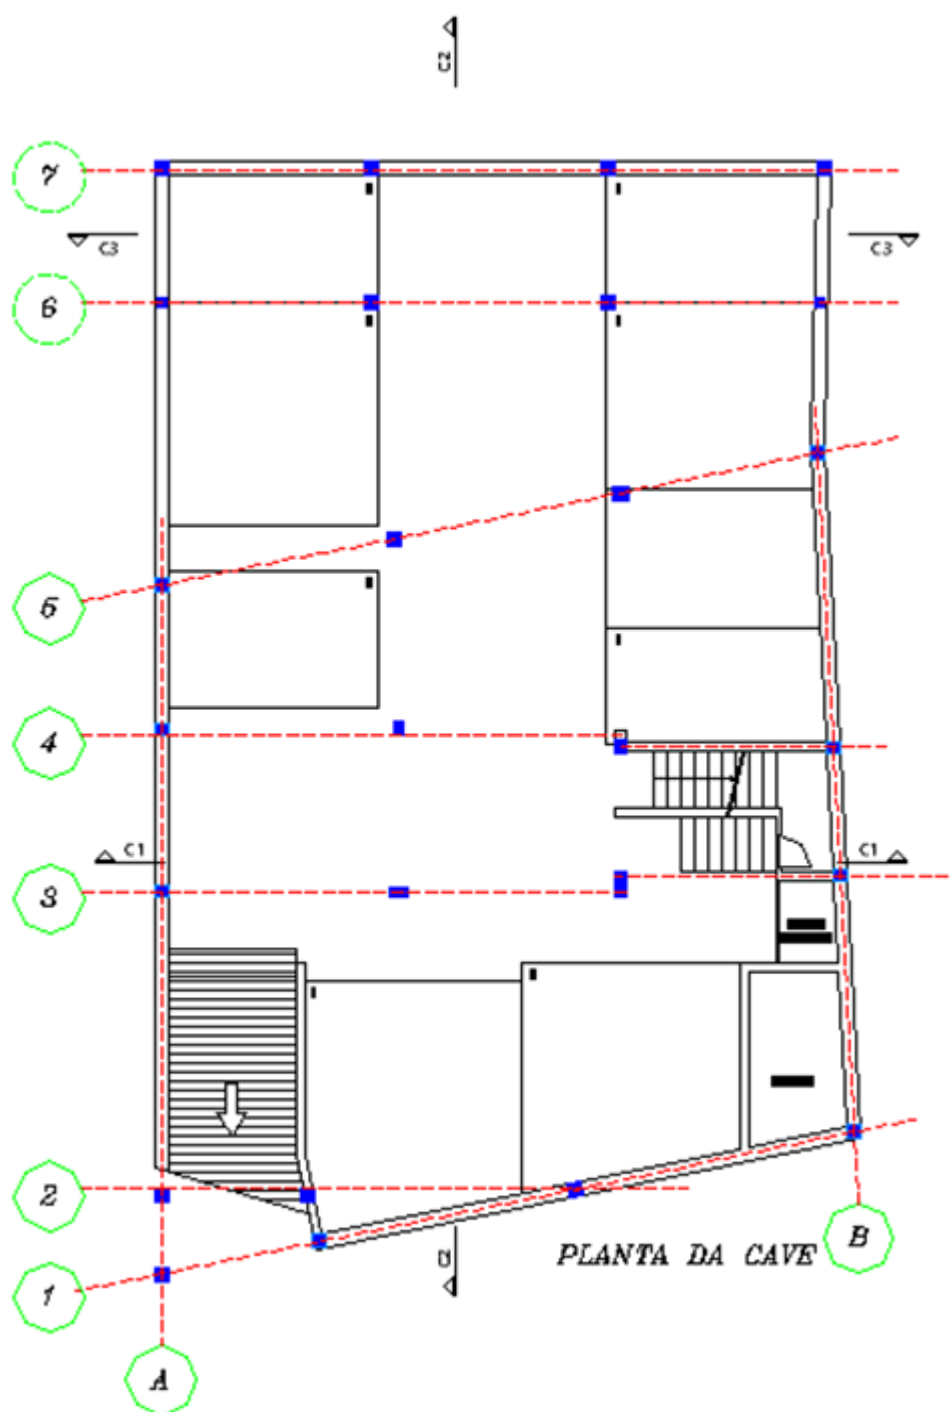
Solução estrutura adotada na planta da cave (sem escala)
